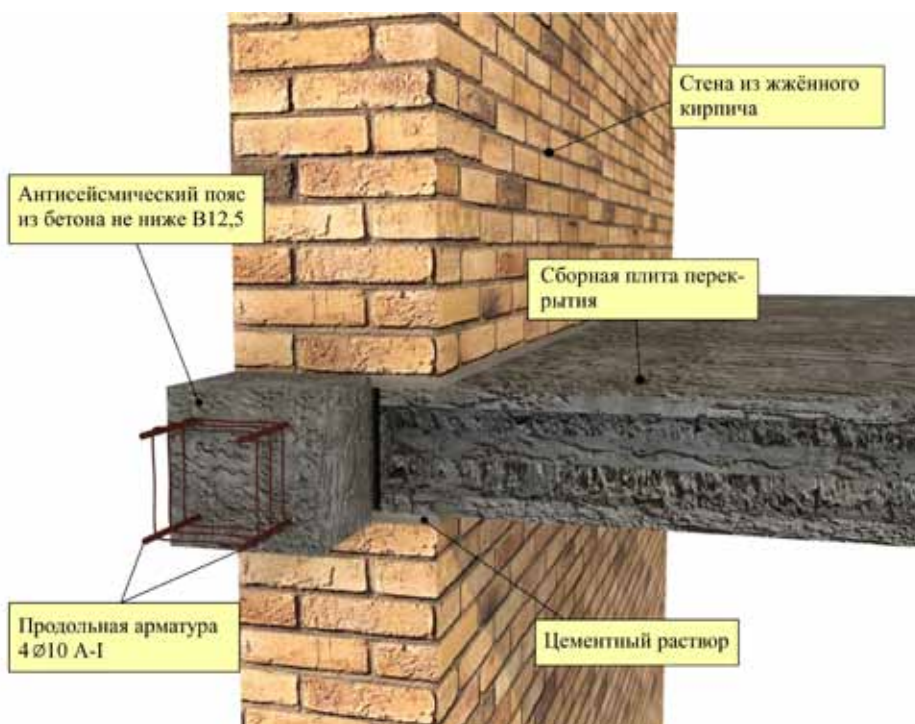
Железобетонный антисейсмический пояс на наружной стене
